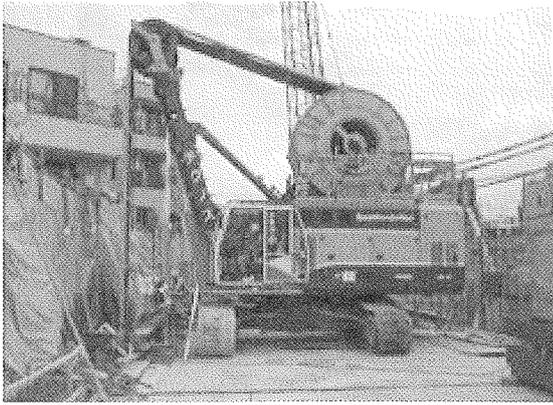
13号線雑司ヶ谷二工区土木工事の施工状況
